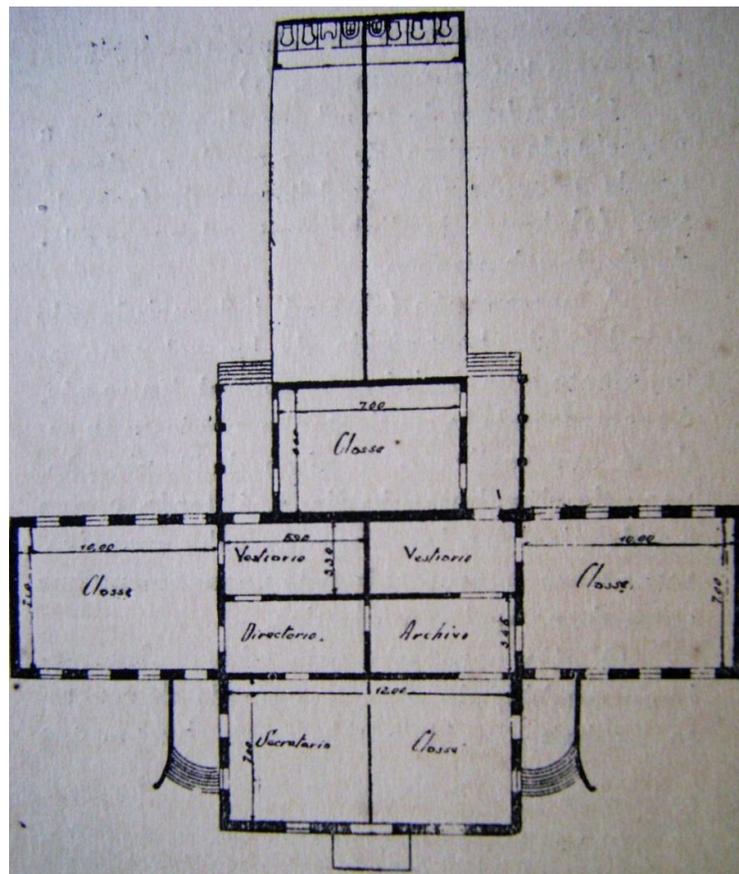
Planta baixa do prédio escolar Augusto Severo.
